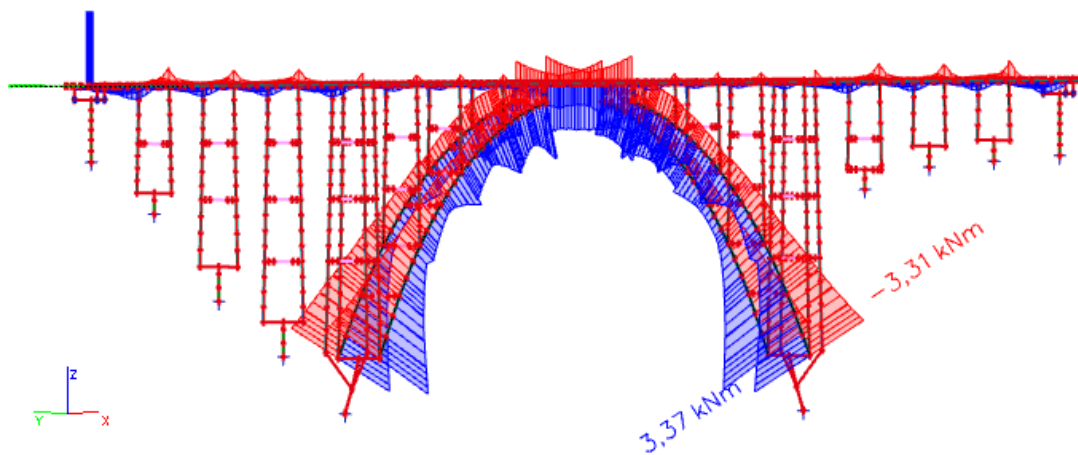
Výhradní zatížitelnost – umístění šestinápravového vozidla na konstrukci – varianta 2
